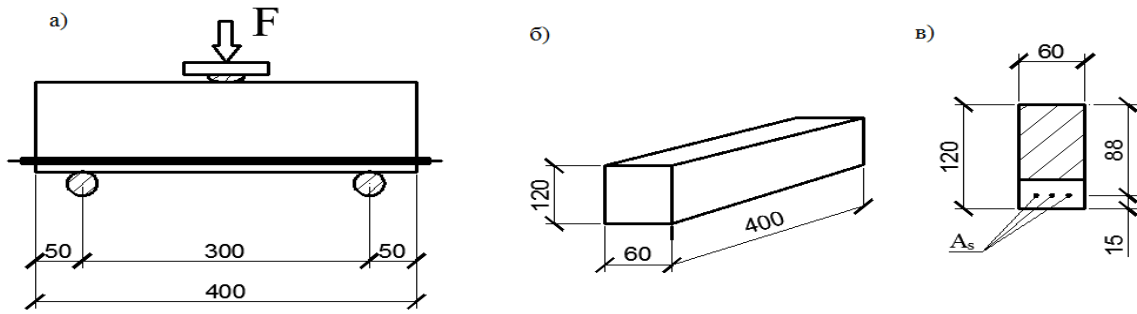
Балка, армированная АСП: а – расчетная схема; б – геометрические размеры; в – схема армирования
